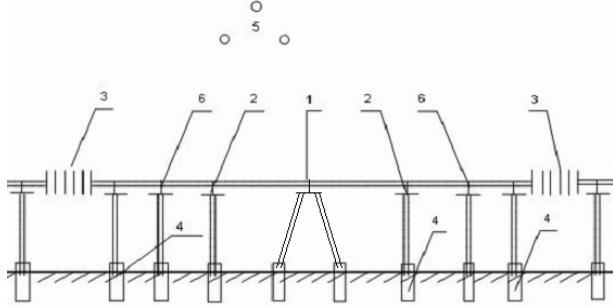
Пример надземной прокладки трубопроводных участков ЗС: 1 – неподвижная опора; 2 – подвижная опора; 3 – сифонные компенсаторы продольных, поперечных и угловых перемещений; 4 – заземлители опор; 5 – фазные провода ВЛЭП
